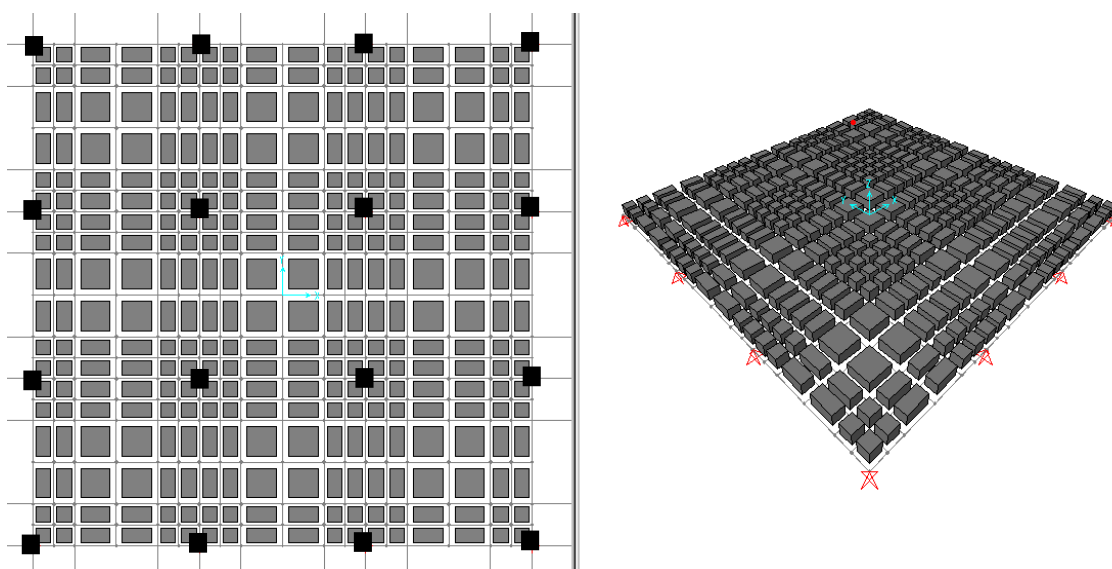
Modelo de estrutura “floor” do SAP2000, utilizado para o cálculo de lajes planas.
